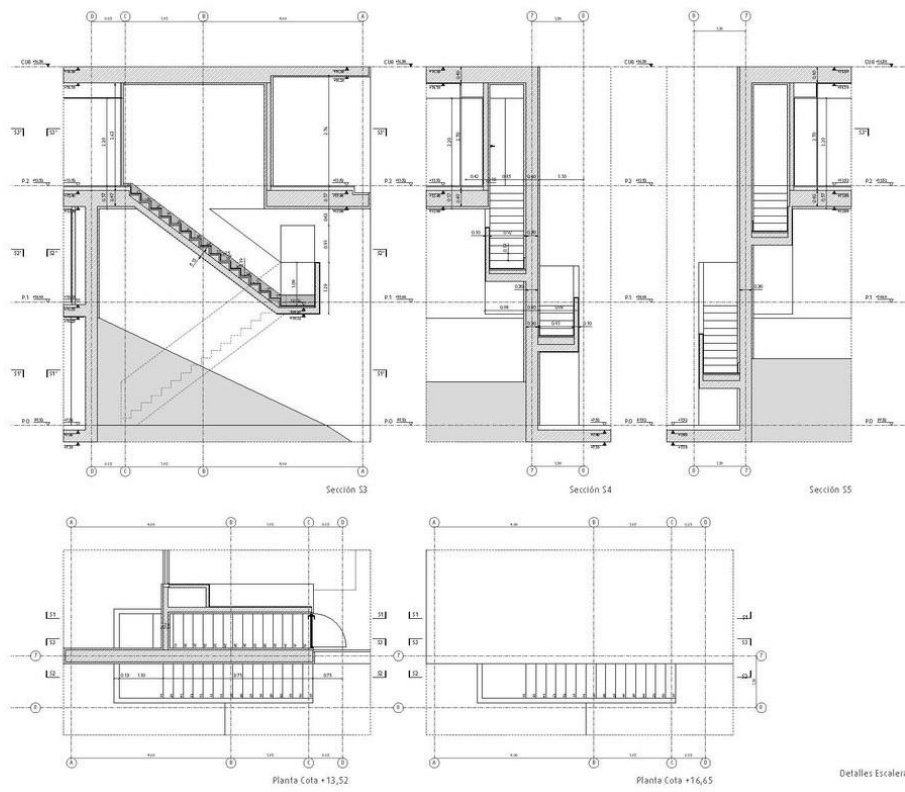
Detalle escalera 01. Fuente: Fran Silvestre Arquitectos.
